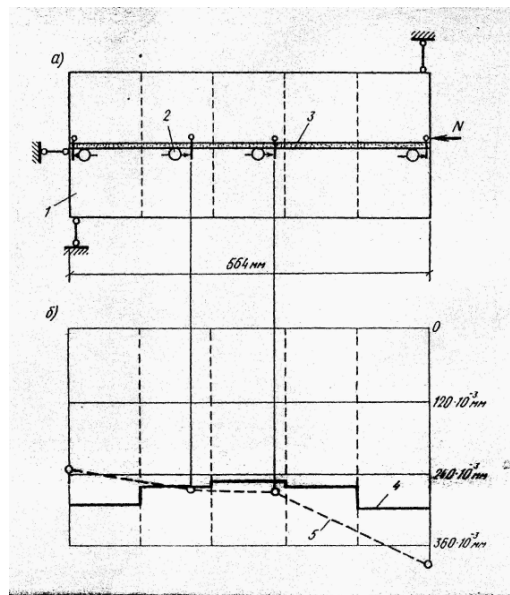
Испытание двухплитной модели на сдвиг по продольному шву: а – схема испытания; б – эпюра сдвигов по шву; 1 – плиты; 2 – индикаторы; 3 – растворный шов; 4 – расчет; 5 – опыт
